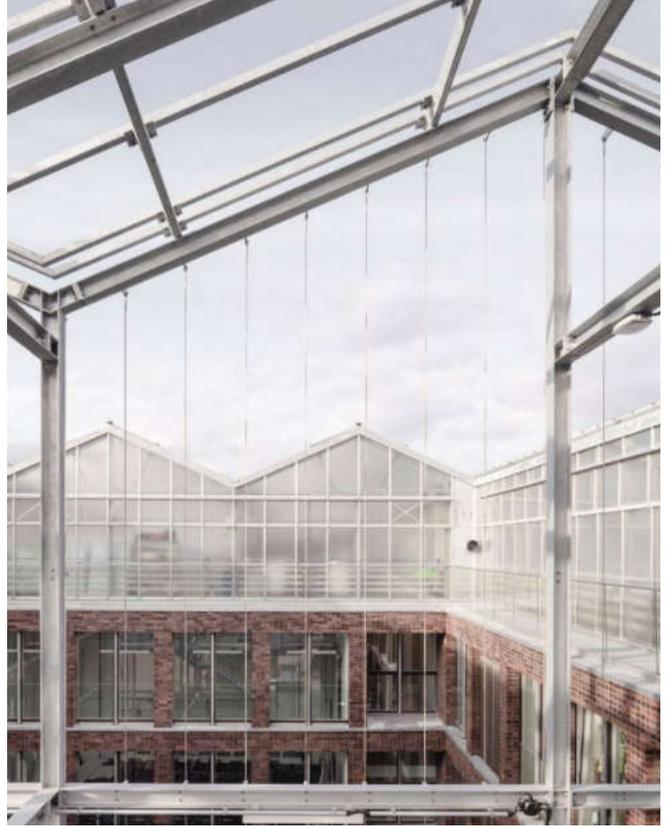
Gerüst und Dach. Quelle: David Hiepler, Fritz Brunier
